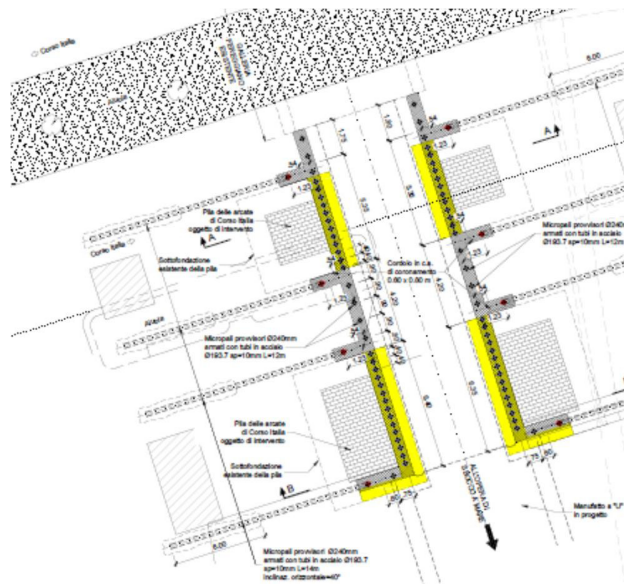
Planimetria dell'intervento sotto Corso Italia
